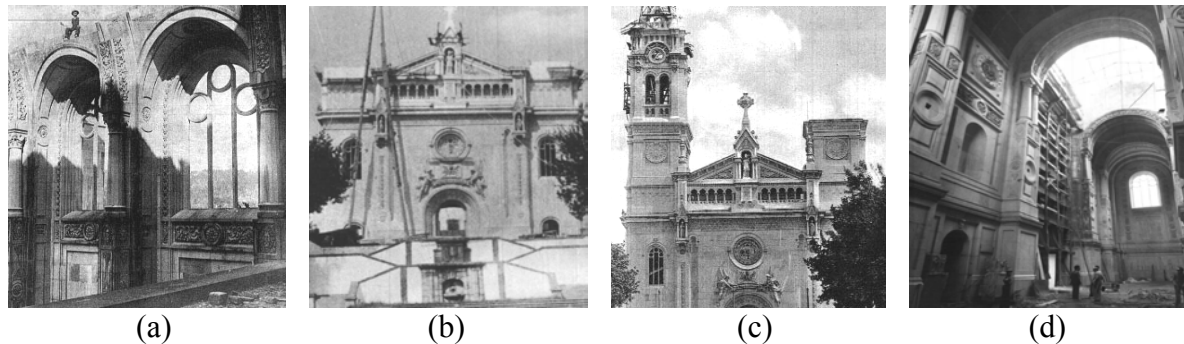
Fases de construção: (a) pormenor dos pilares dos arcos da nave central, (b) acabamento do lintel da fachada e arranque de construção da primeira torre, (c) construção da segunda torre e (d) transepto inacabado
